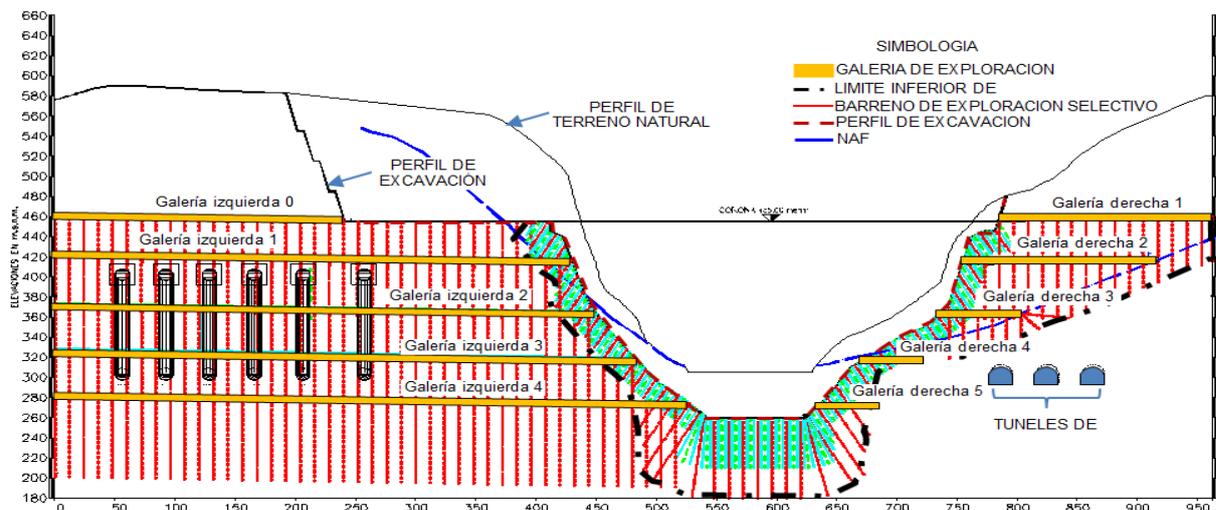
Perfil desarrollado por el eje de la pantalla impermeable, obras subterráneas
